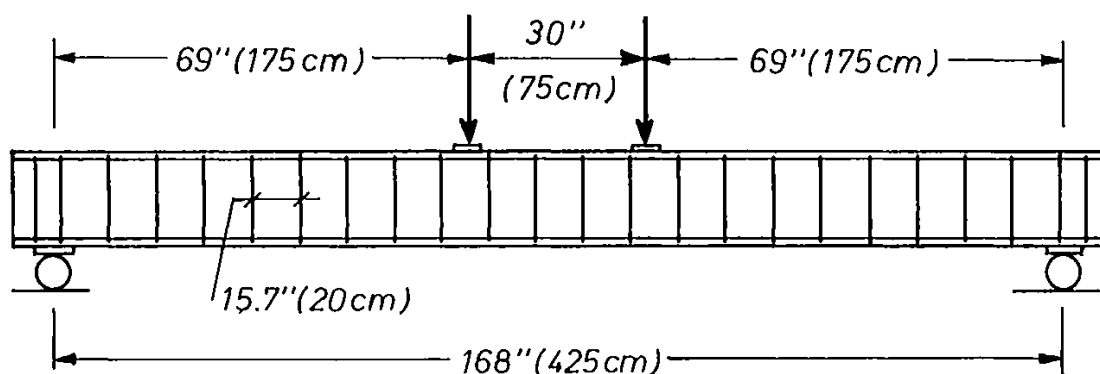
Dimensões das vigas (RUHNAU, 1974).
